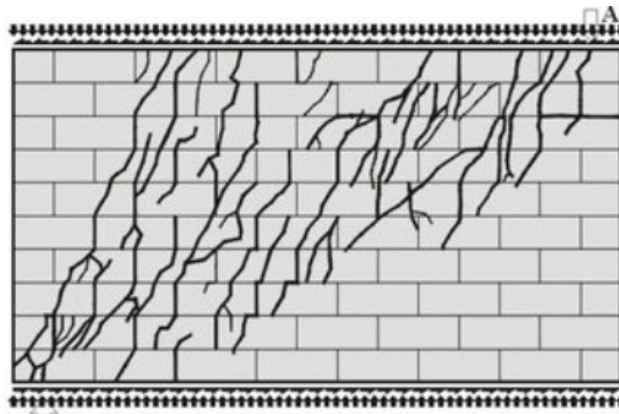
Тріщиноутворення кам'яних стін (Cracking patterns of walls) / Cracking patterns of walls
